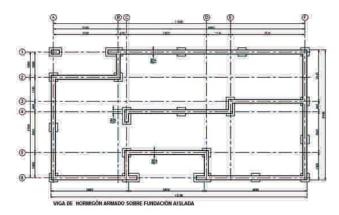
37 : Plano de fundación aislada con viga de hormigón armado, donde se especifican los ejes que es necesario replantear para los cimientos aislados.
